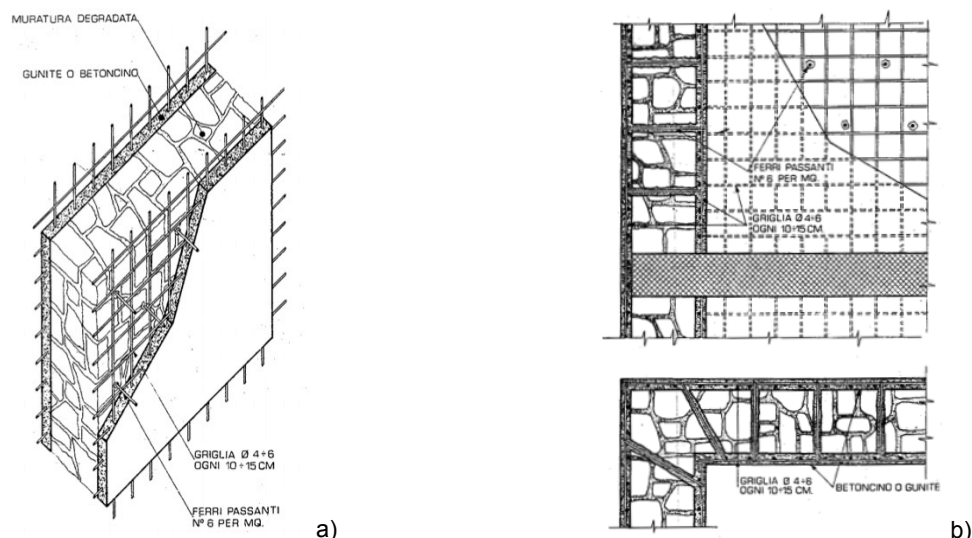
Consolidamento di muratura mediante lastre sottili armate con rete elettrosaldata in acciaio e collegate da ferri passanti. Vista assonometrica; sezioni orizzontale e verticale. (Disarò, 2000)
